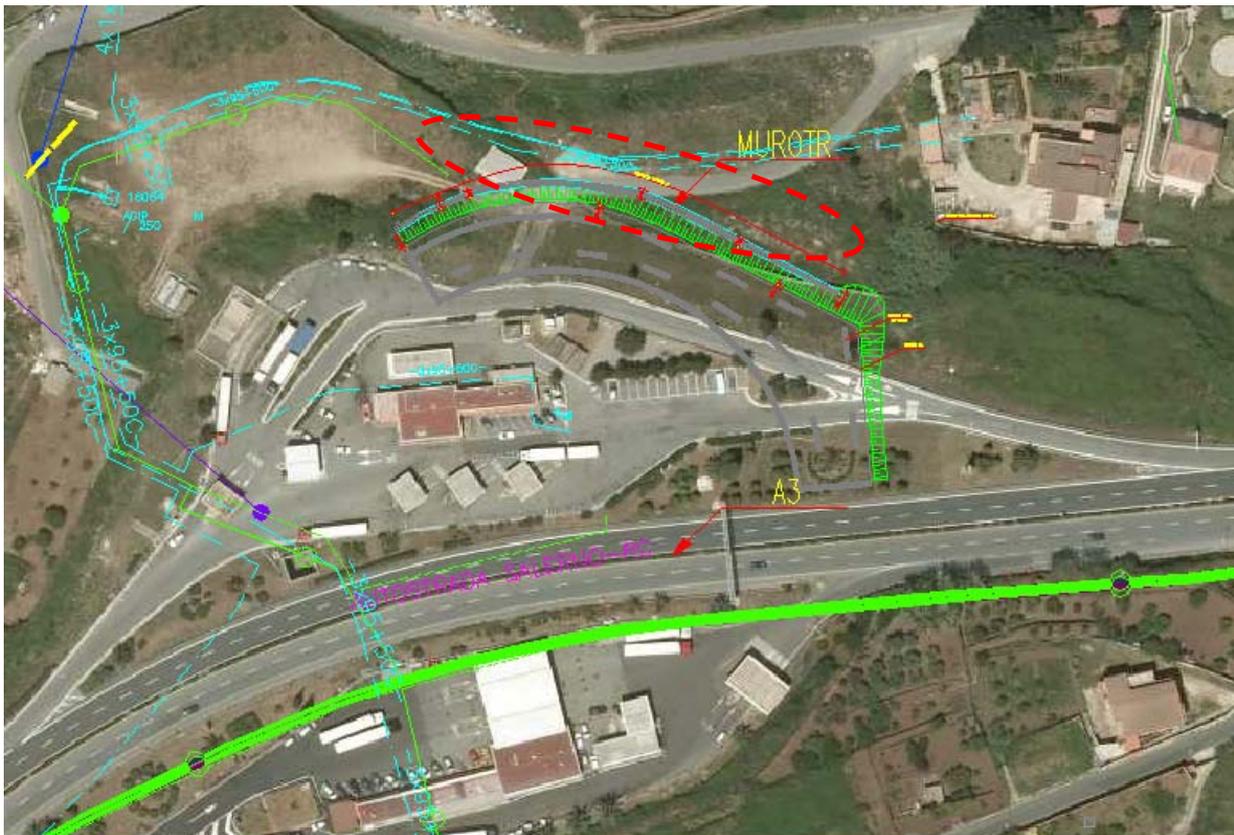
Stralcio Planimetrico dell'opera con indicazioni dei sottoservizi
